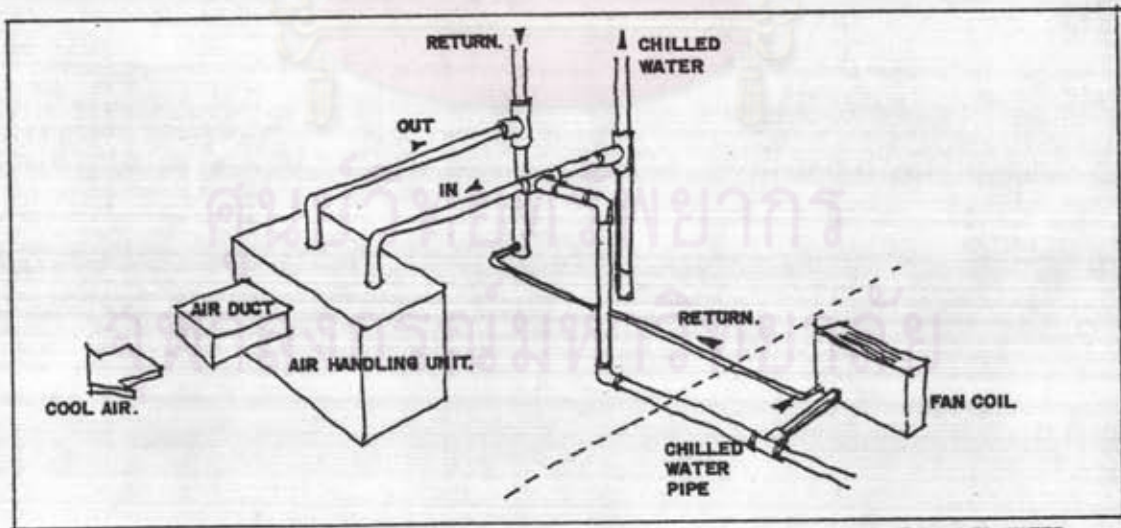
ระบบ PACKAGE TYPE WATER COOL
